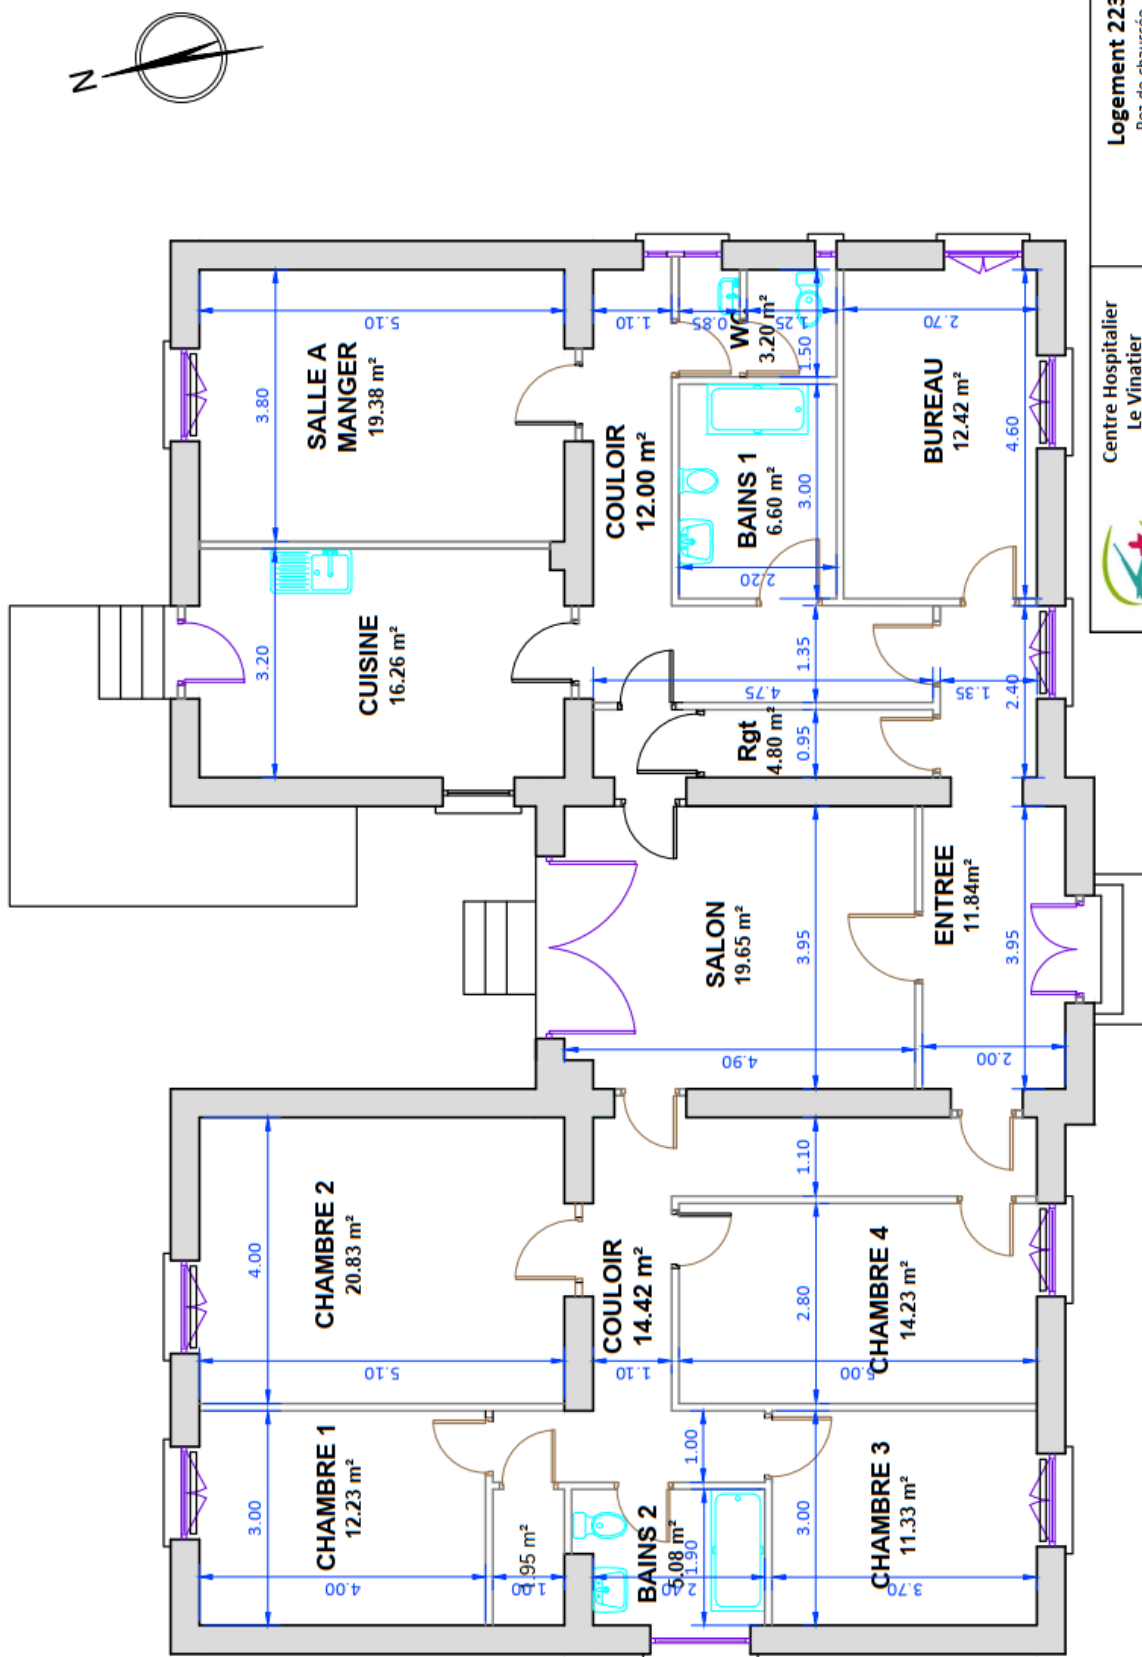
Vue en plan Logement 223 - Rez-de-chaussée
